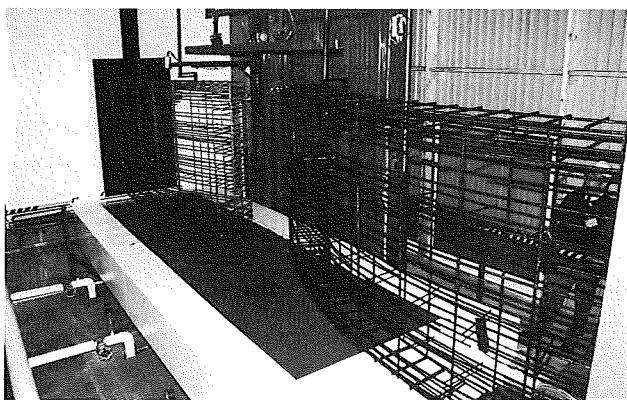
Técnica del baño fluidizado usado para el recubrimiento de capa de epoxy de gabiones de armadura 3-D completamente soldados, limpiados por chorro de arena y precalentados.
